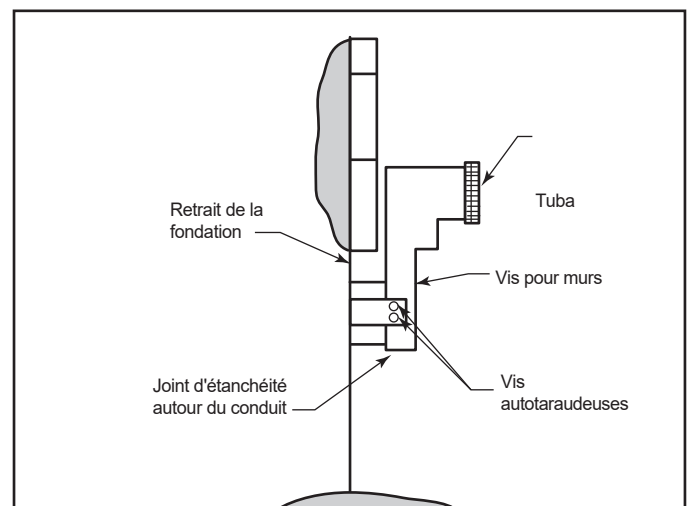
Installation d'un col d'entrée d'air, fondation encastrée
